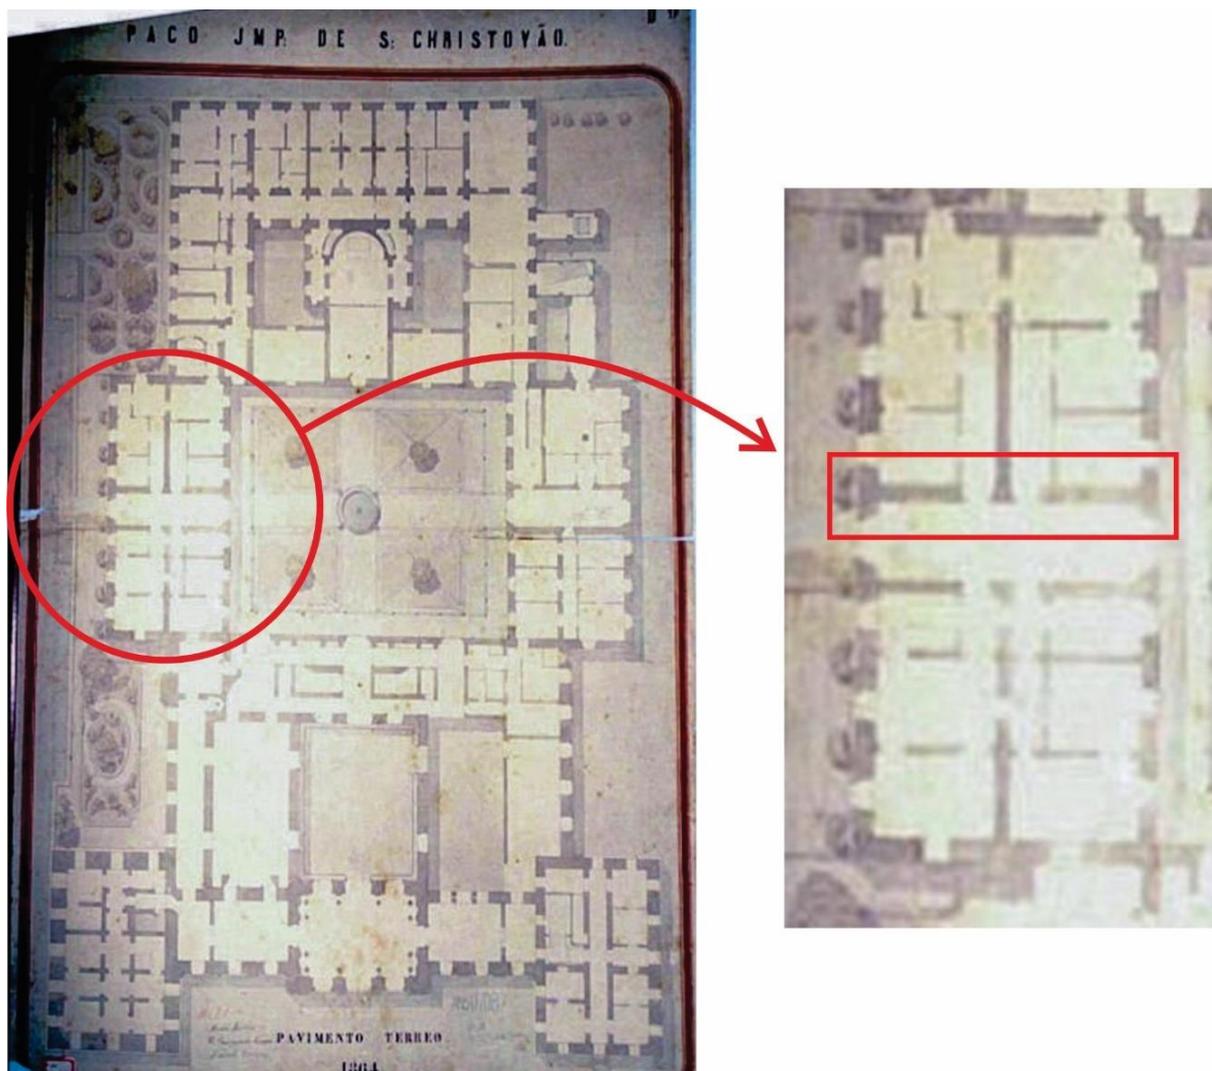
Planta Baixa de 1864 do 1º pavimento com detalhe para o Bloco II – Sul, ratificando a inexistência dos outros vãos existentes no Paço atual (em vermelho).
